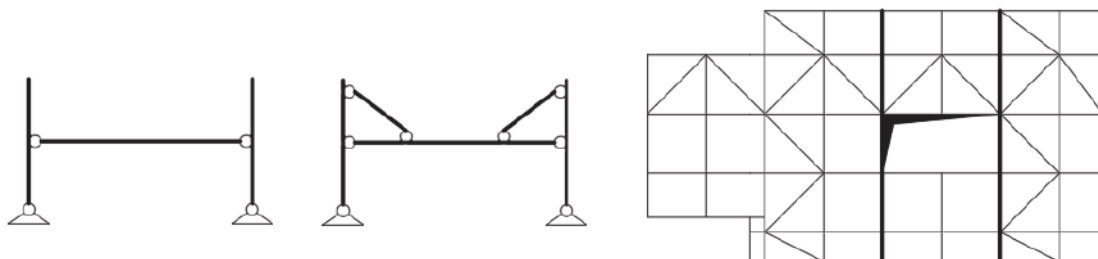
Schema strutturale con e senza la partecipazione della struttura del tetto e schema strutturale del traliccio di controventamento inserito nel controsoffitto
